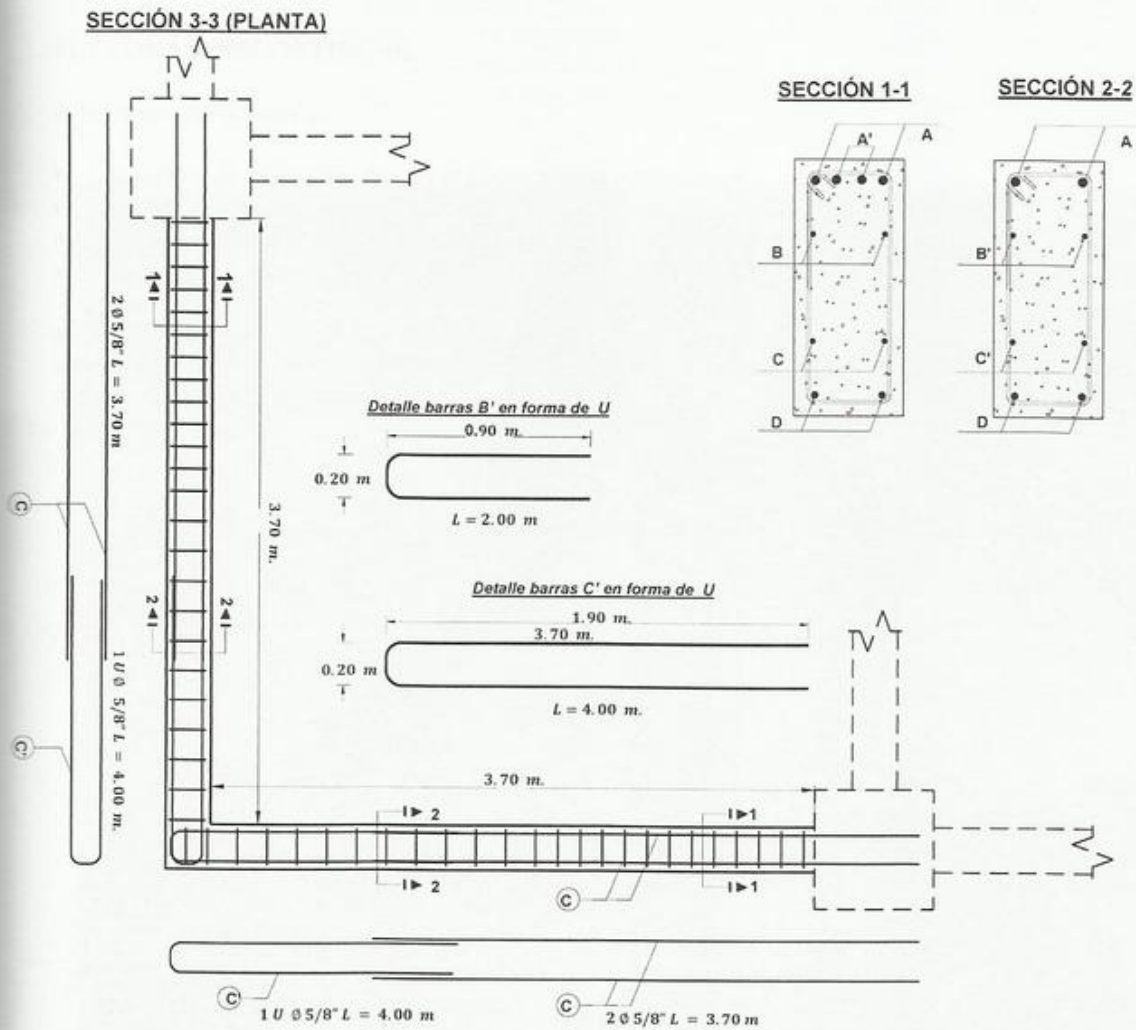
Despiece de la viga del Ejemplo 10.1 (En planta)
